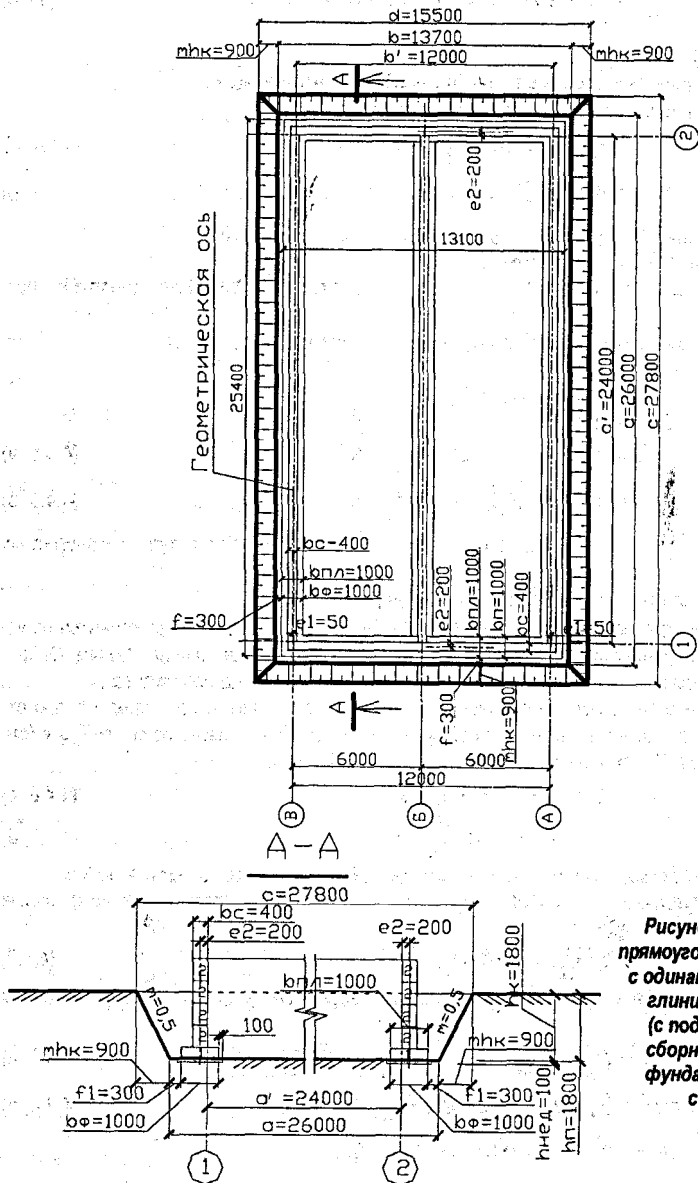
Схема прямоугольного котлована с одинаковой глубиной в глинистых грунтах (с подготовкой) под сборные ленточные фундаменты здания с подвалом
